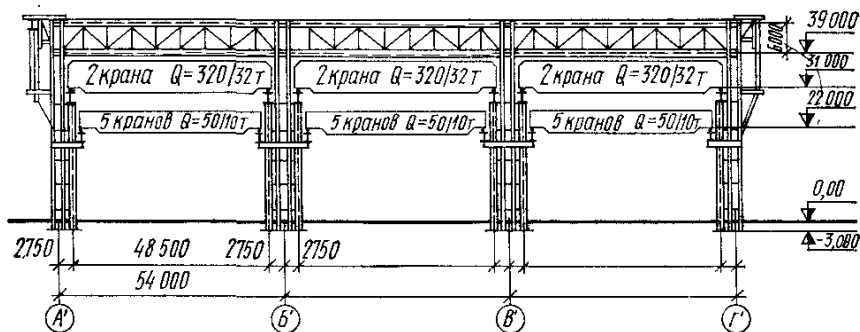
Поперечный разрез сборочно-сварочного цеха с двухъярусным расположением кранов
